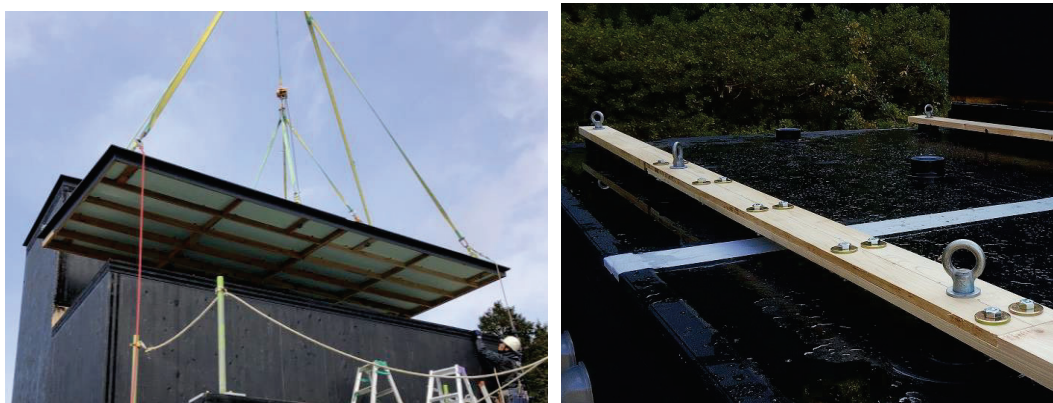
屋根ユニットの揚重方法最終案
